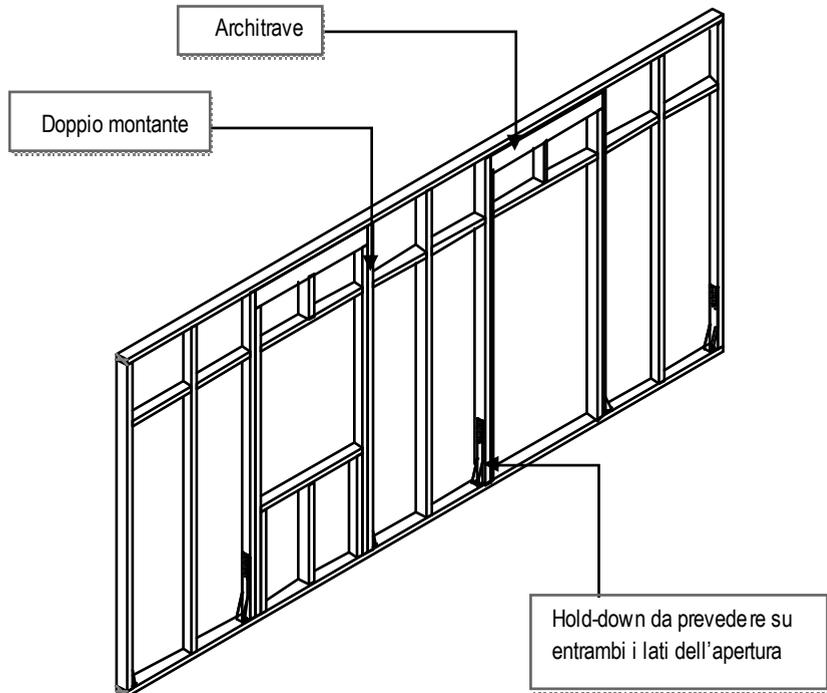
Dettaglio del telaio della parete con aperture per porte e finestre.
